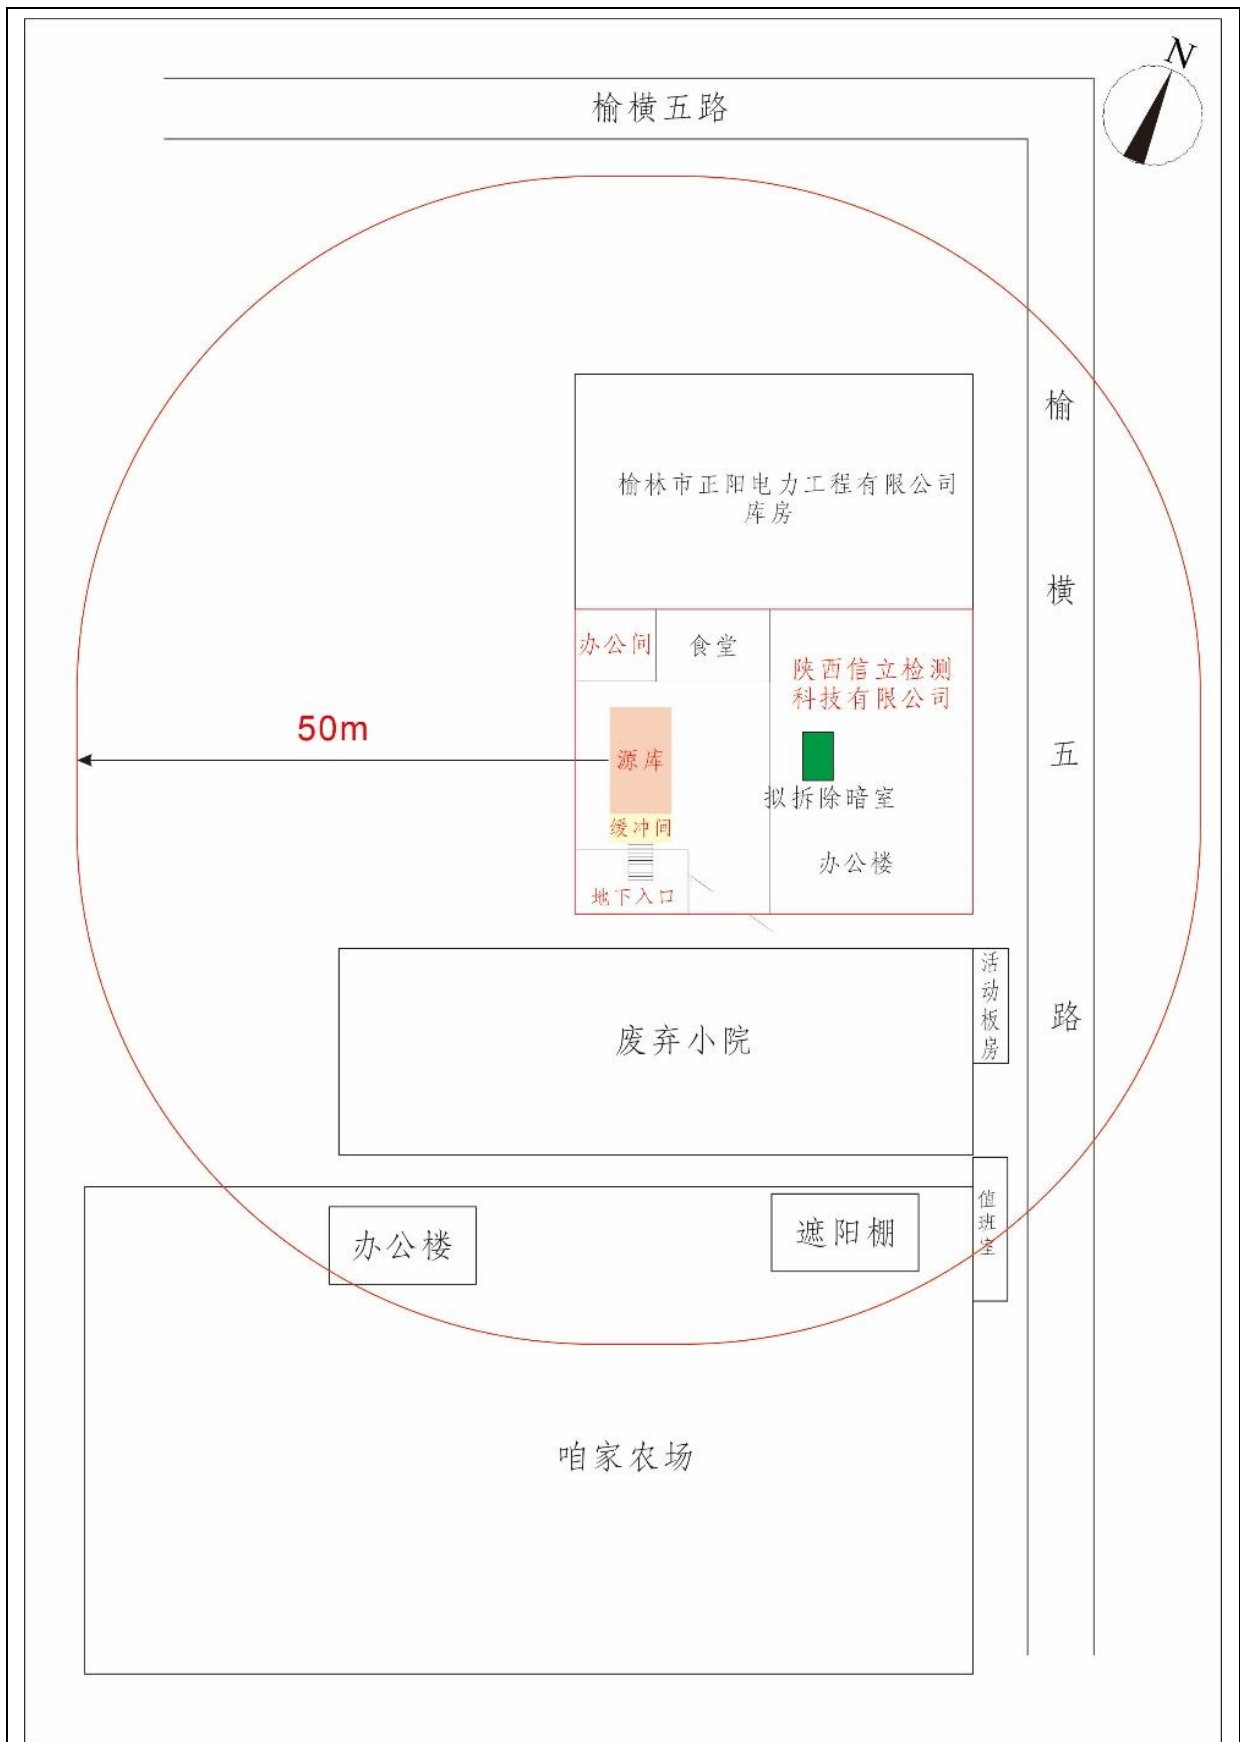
陕西信立监测科技有限公司密封源库平面布置图
